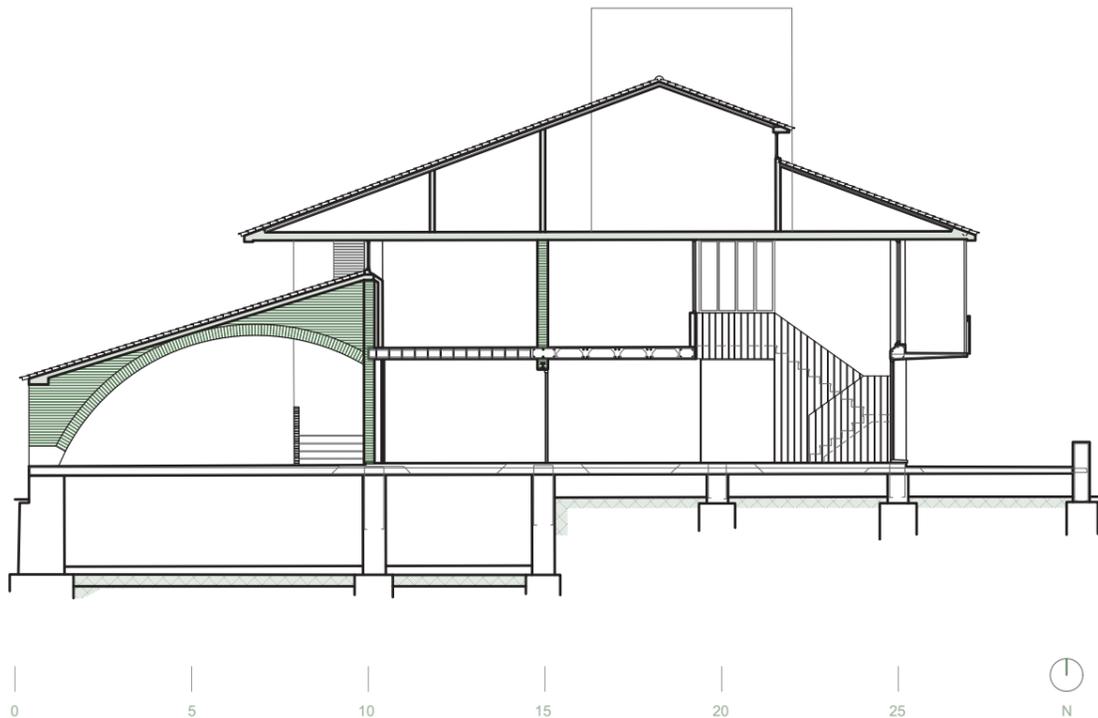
Sección transversal constructiva, Casa Añón. Escala 1:200. Elaboración propia.
